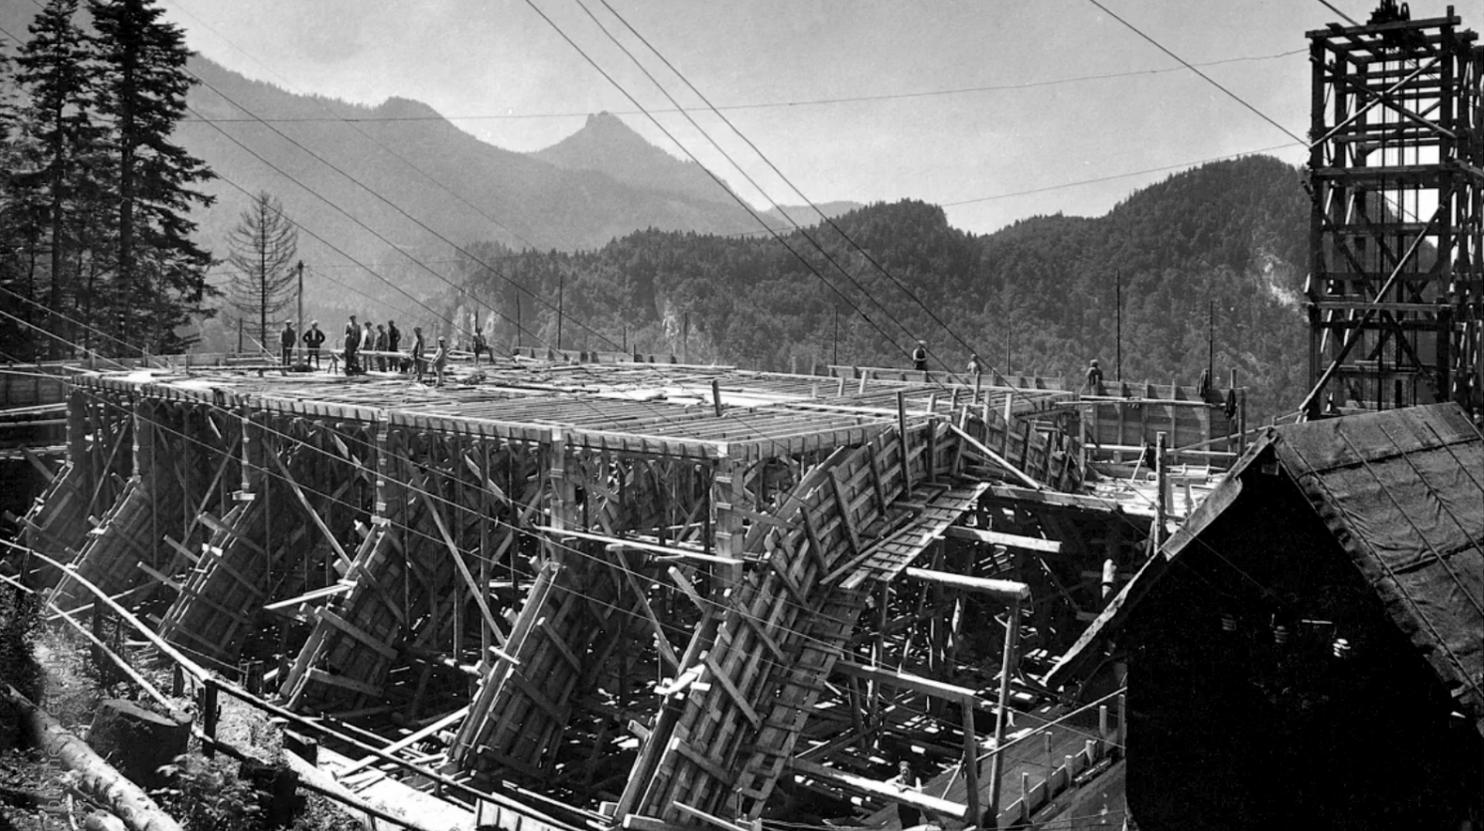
Bau des Walchenseekraftwerks, o.D.
